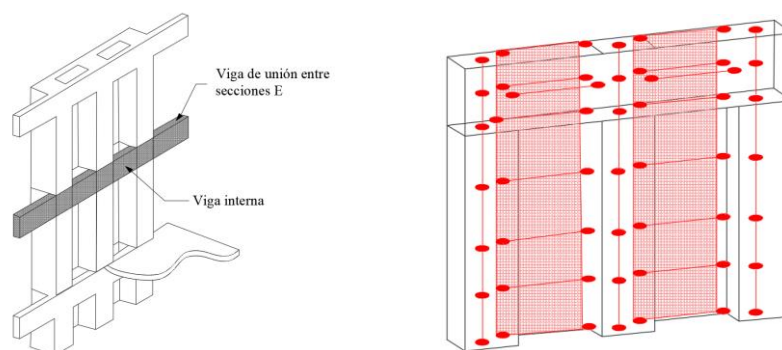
Tramo de columna de sección tipo E y Modelación muro de sección tipo E, respectivamente (Aguilar, 2016).
